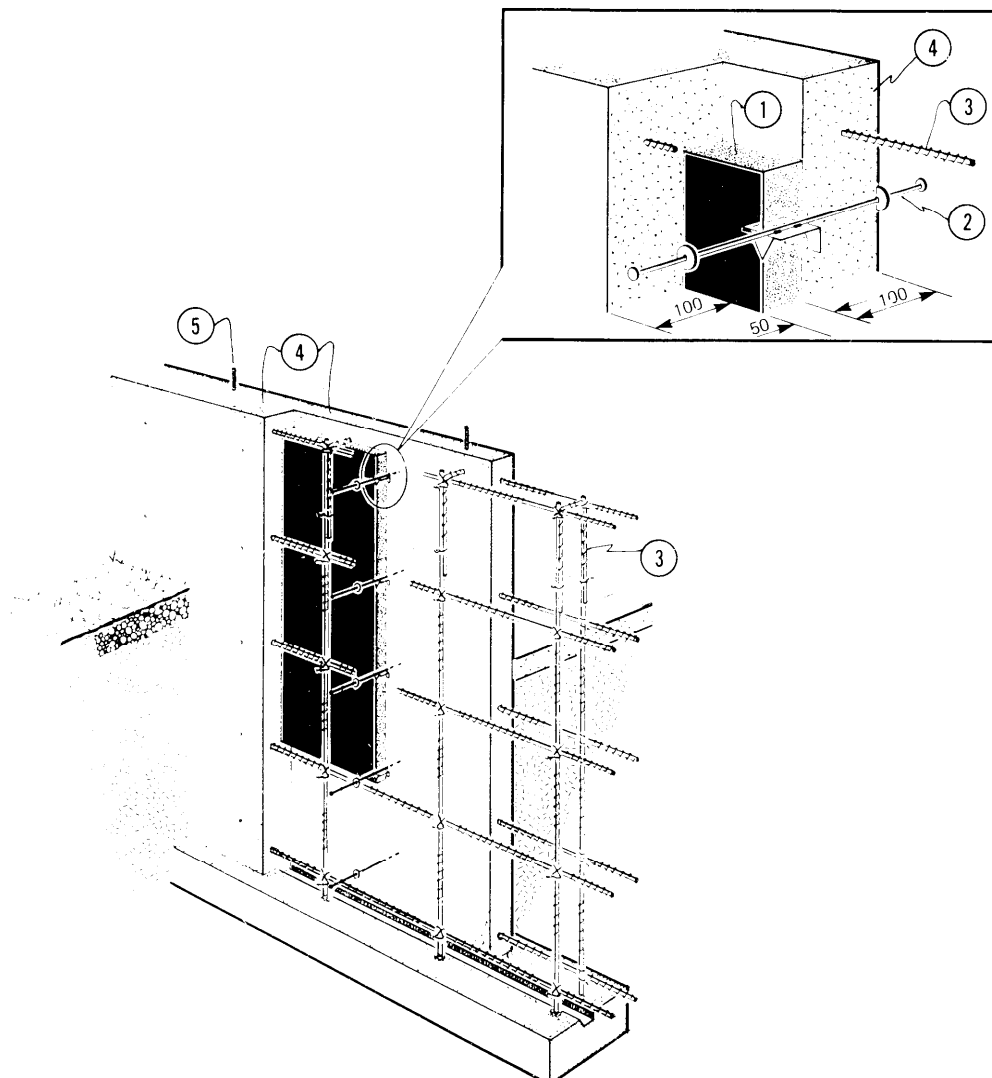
Murs isolés à charpente à poteaux (plan M-9314)
